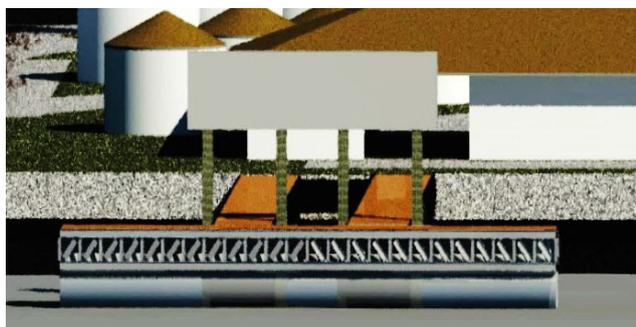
Vista frontal do pórtico que sustenta a estrutura do píer.
